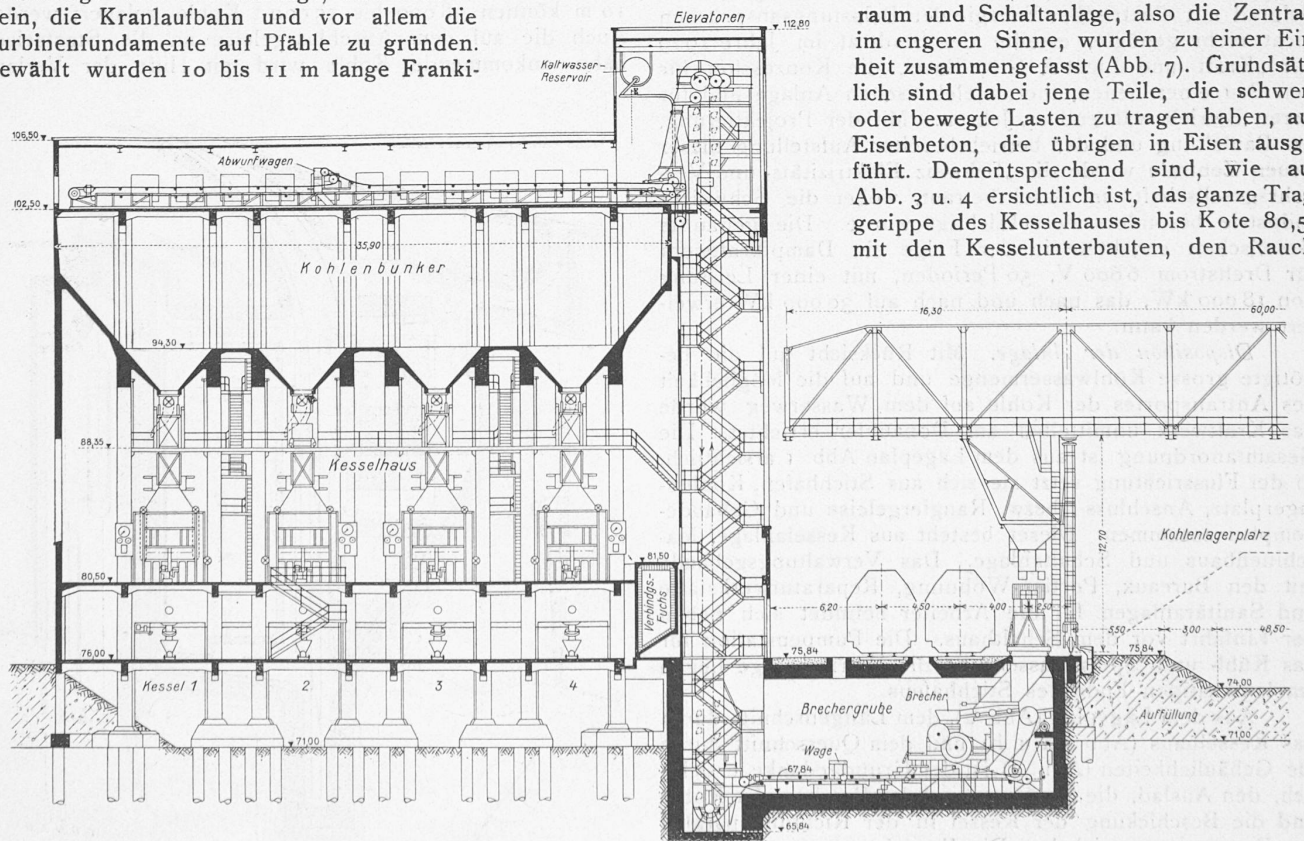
Links Kesselhaus-Längsschnitt und Brechergrube. Rechts Ansicht der Verladebrücke und Schnitt durch den Kohlenlagerplatz. — Masstab 1:400.
